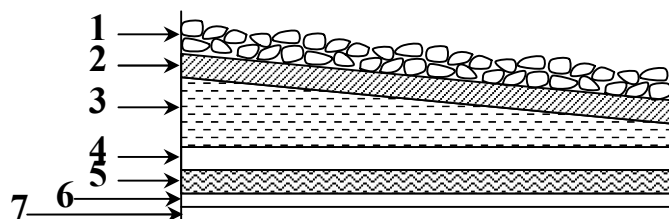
Coupe verticale d'un plancher terrasse.
